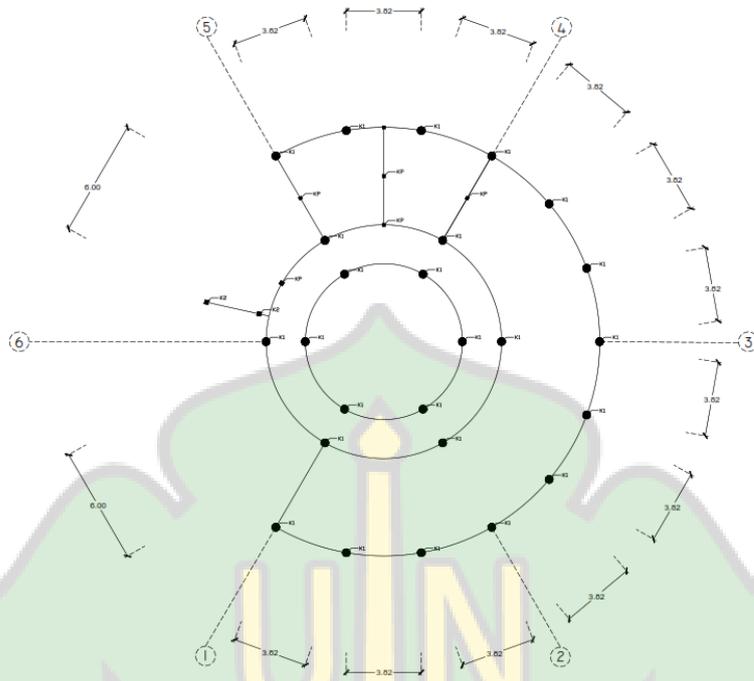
Denah Balok Elevasi +4.50 Lobby dan Pengelola
